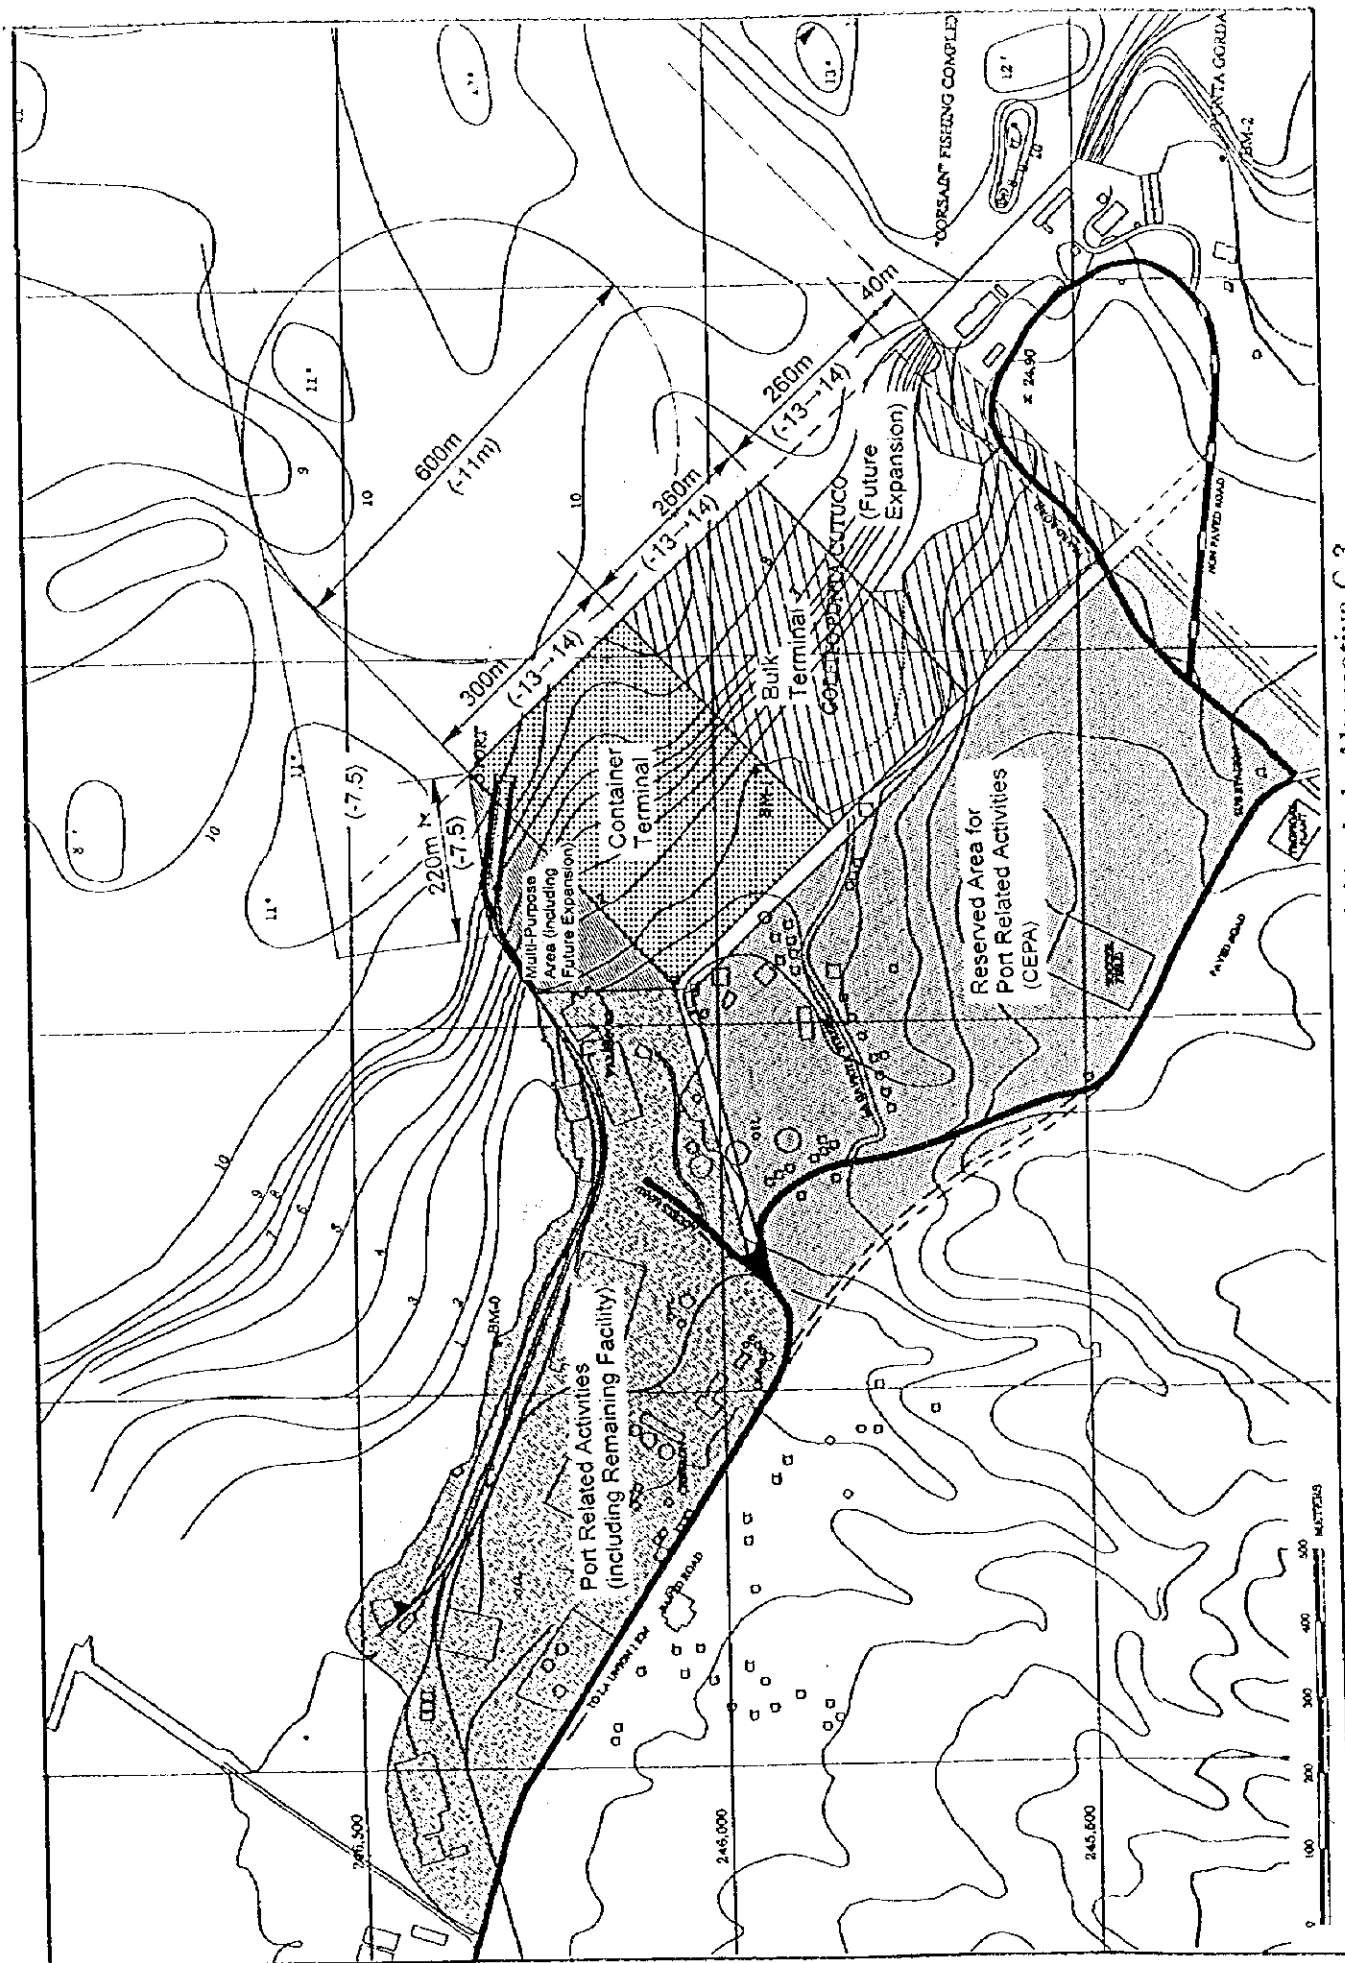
Plano de Disposición de la Alternativa C-3
